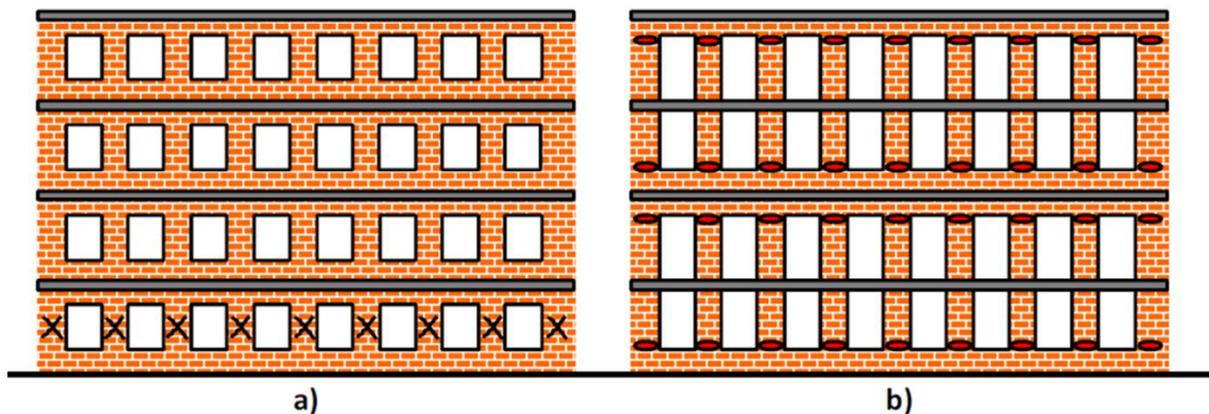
Estructuración de fachada en la dirección larga: a) Original; b) Definitiva
